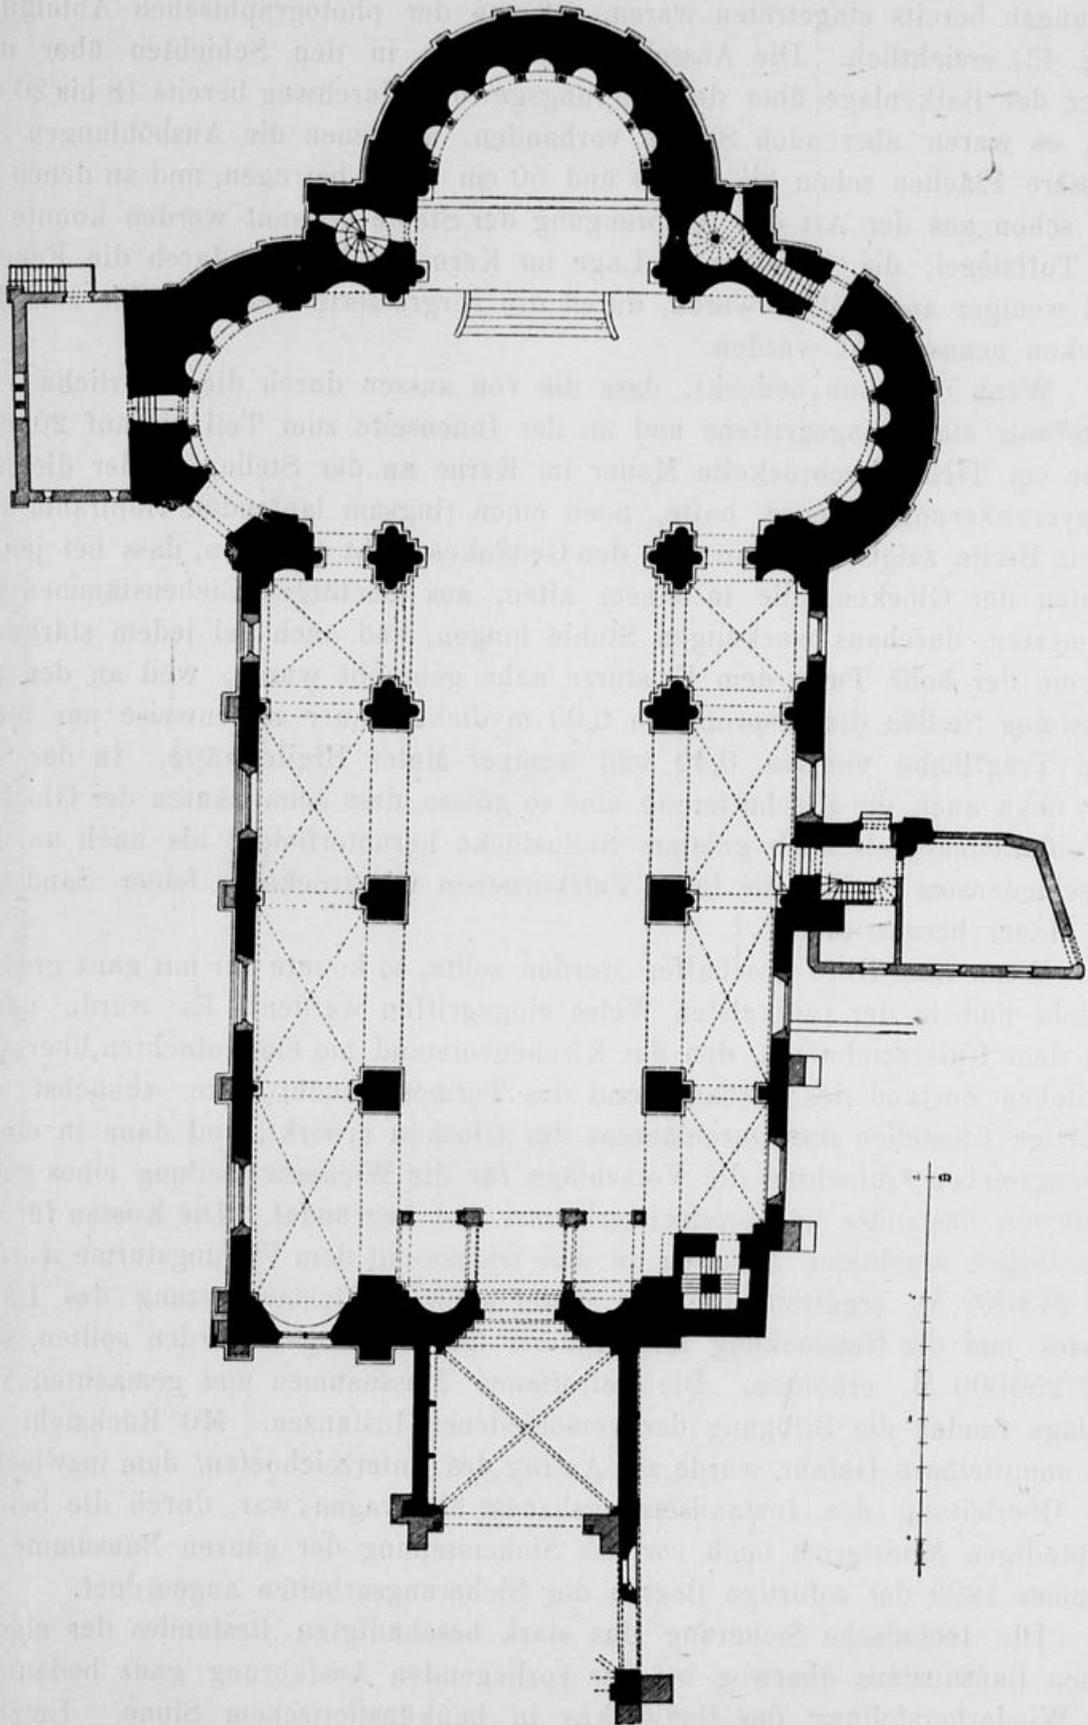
Köln, Gr. St. Martin. Erdgeschossgrundriss.
